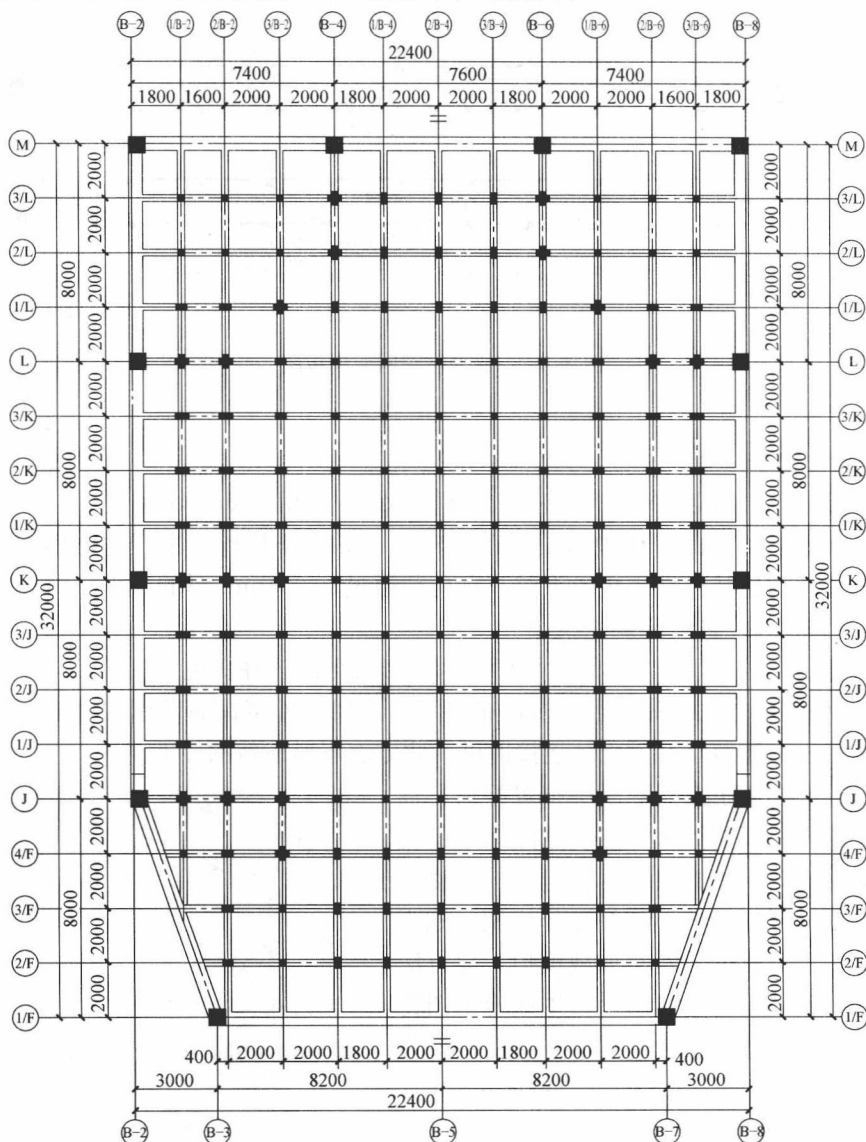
现浇混凝土空腹网架弦杆平面布置图
